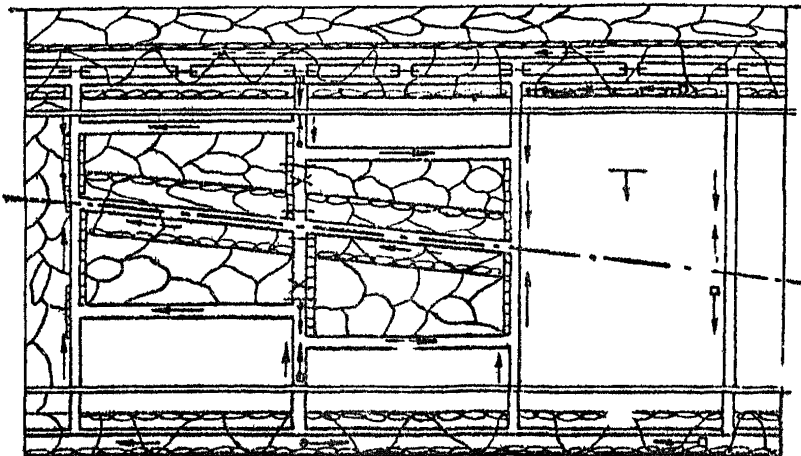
Схема гармоничной подработки вытянутого в плане объекта
